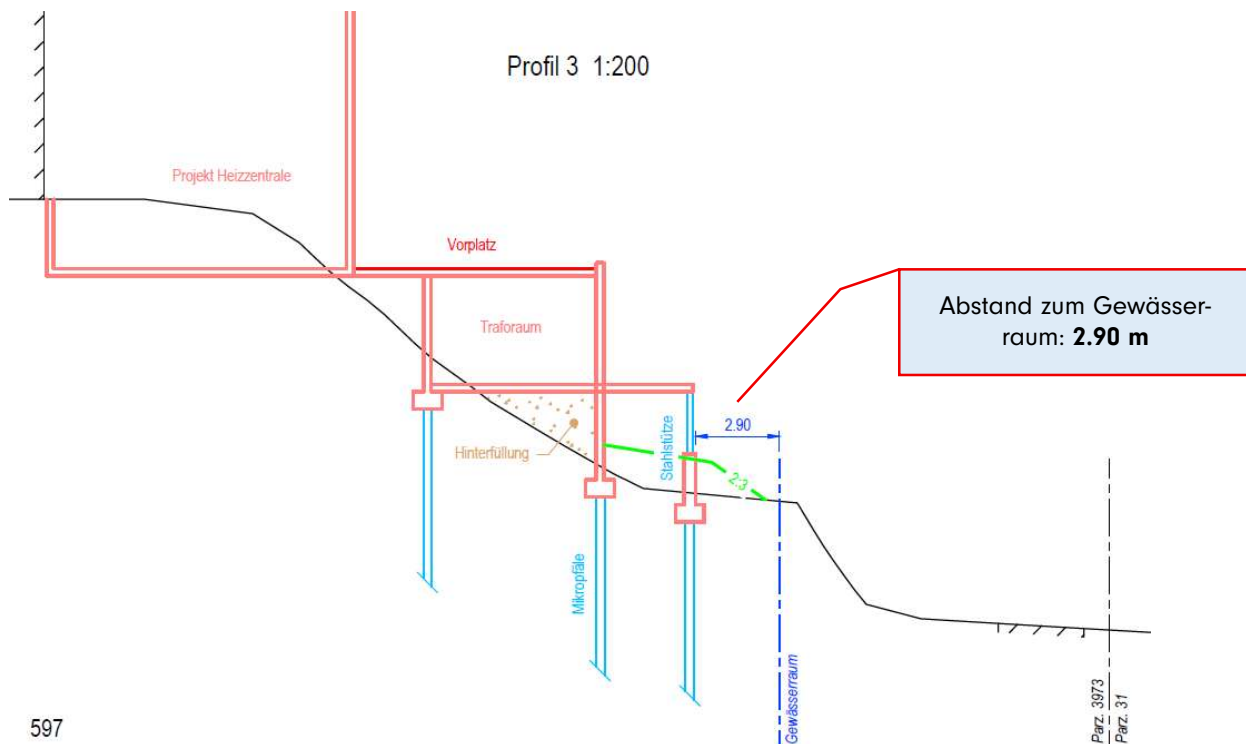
Abstand Vorplatz Traforaum zum Gewässerraum (engste Stelle)
